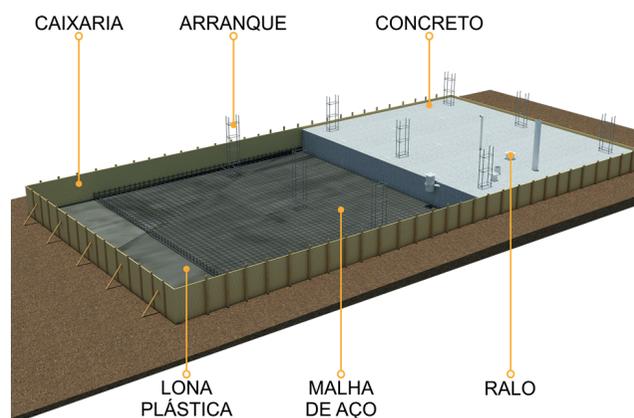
Perspectiva do estruturamento de fundação em radier com concreto armado.
